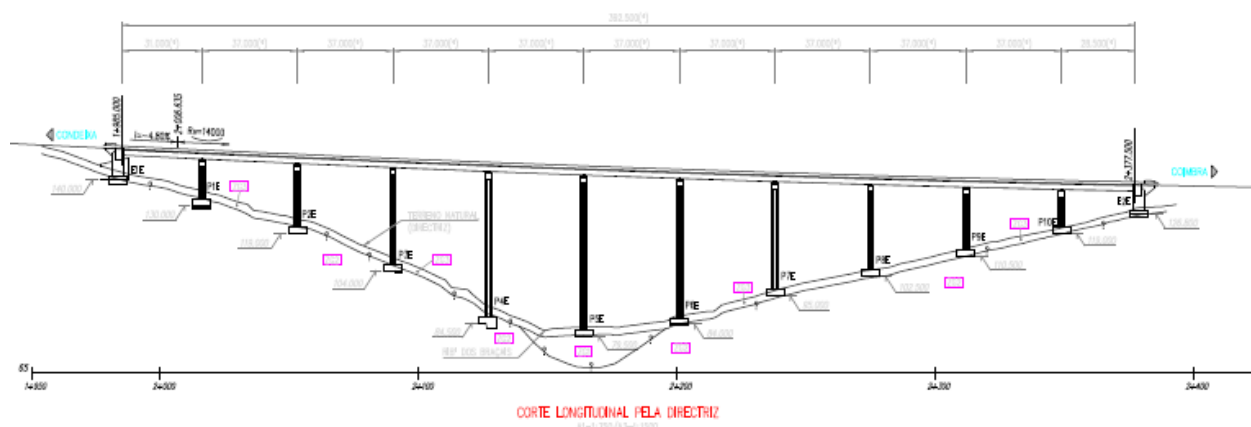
Projeto do Viaduto da Ribeira de Braçais - corte
